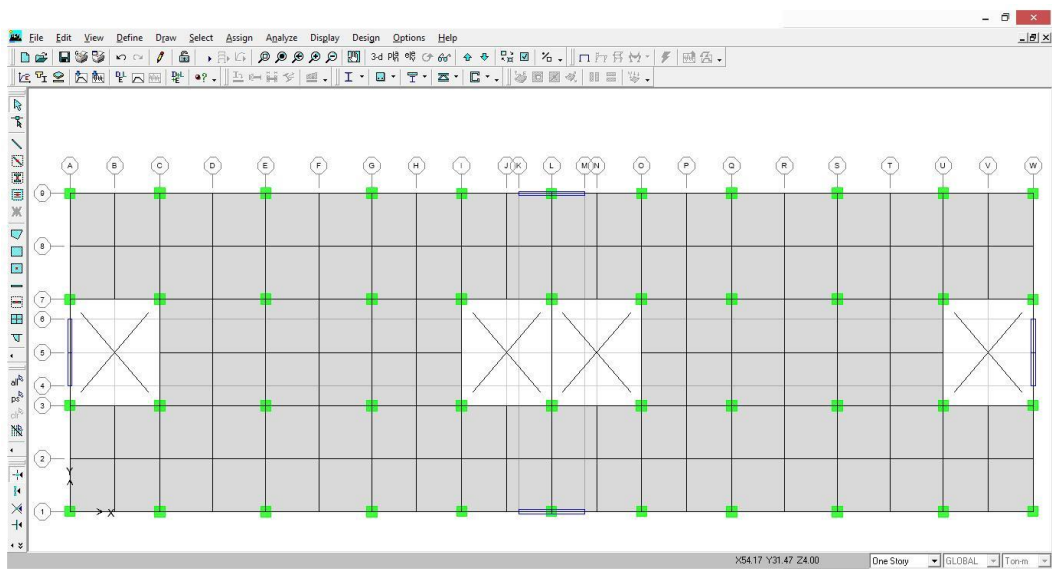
Denah Tampak Samping Arah y Struktur Tanpa *Shearwall
